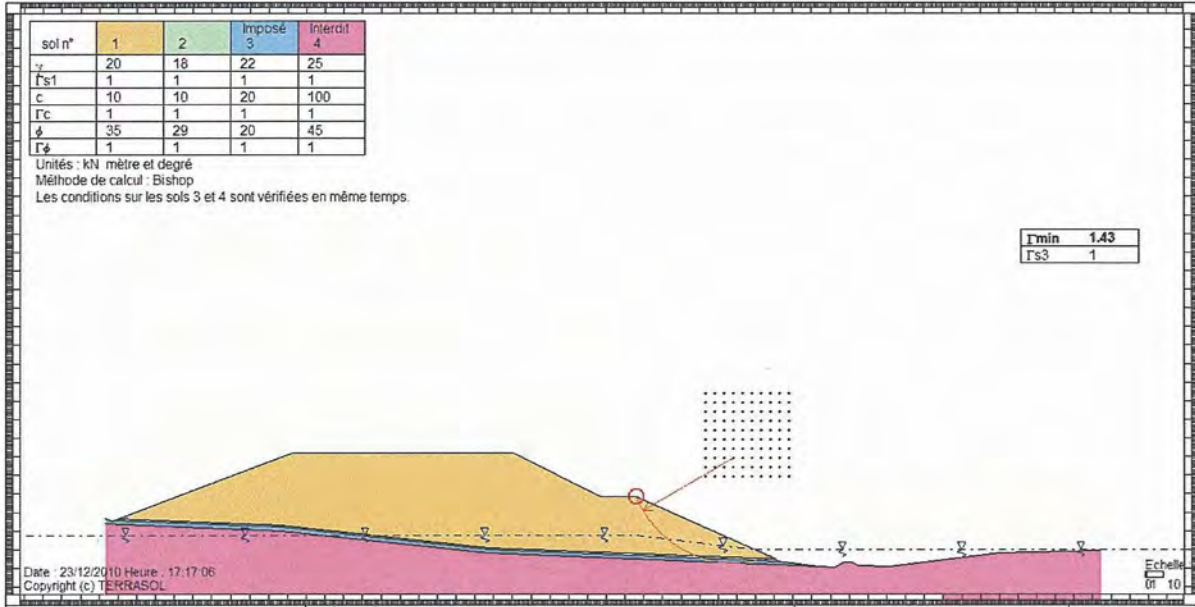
Coupe 3 : Stabilité vis-à-vis d'un glissement profond avec remontée accidentelle du niveau de la nappe
